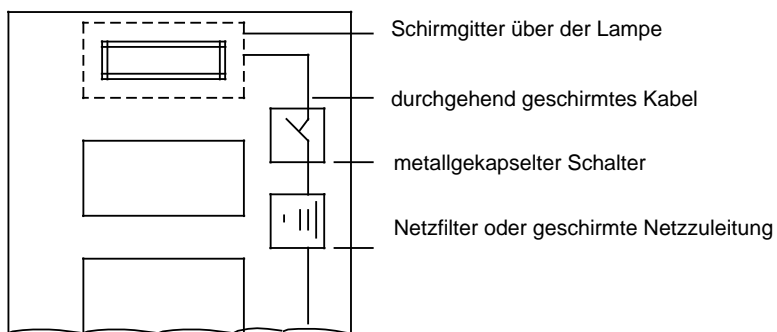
Maßnahmen zur Entstörung von Leuchtstofflampen im Schrank
